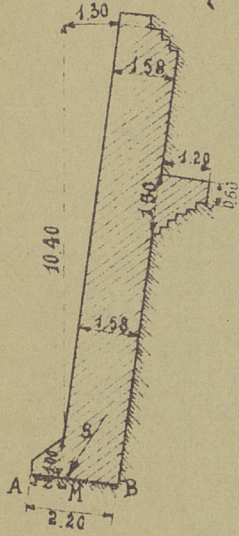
Mur de soutènement en béton armé à semelle sans nervure.
